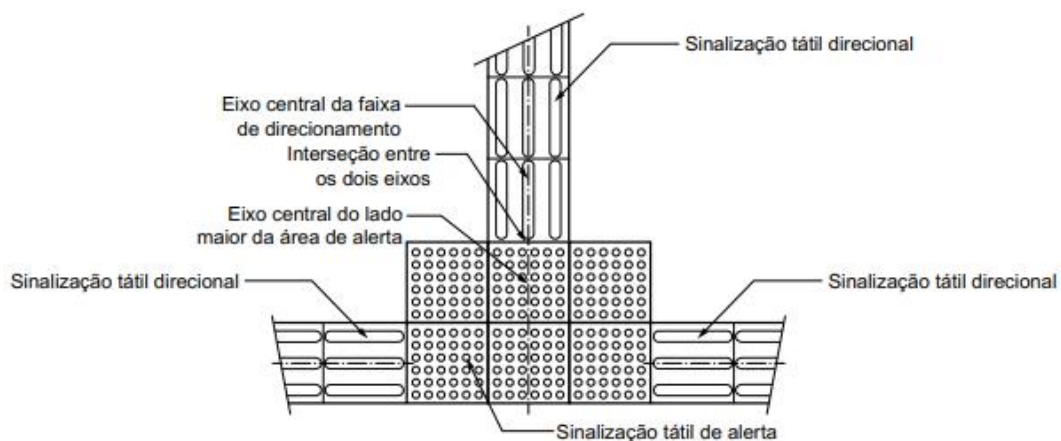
Encontro de três faixas direcionais ortogonais (Fonte: NBR 16537)
